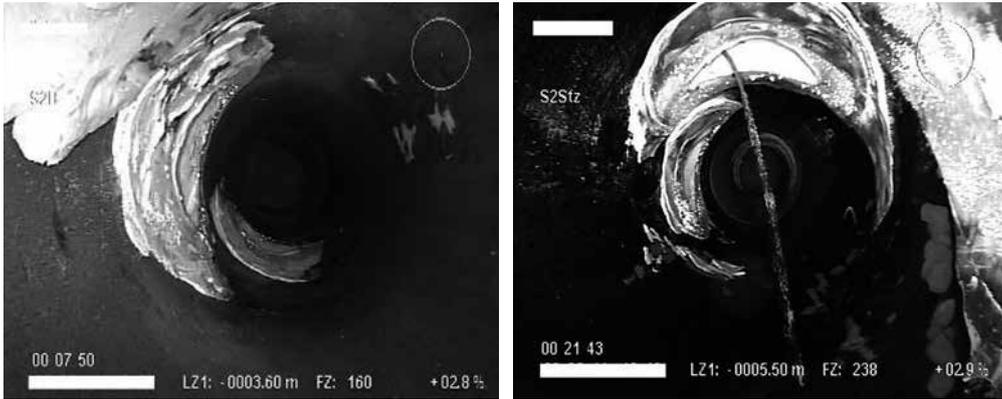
コンクリート管と陶管の高圧洗浄後の流下性能に関する最悪の例 コンクリート管 (左) 陶管 (右)
